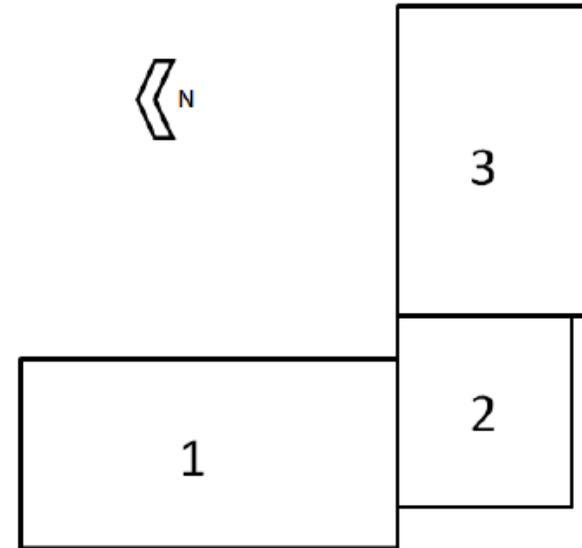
Croquis de plantas de distribución de por edificio. Autoría Propia.
